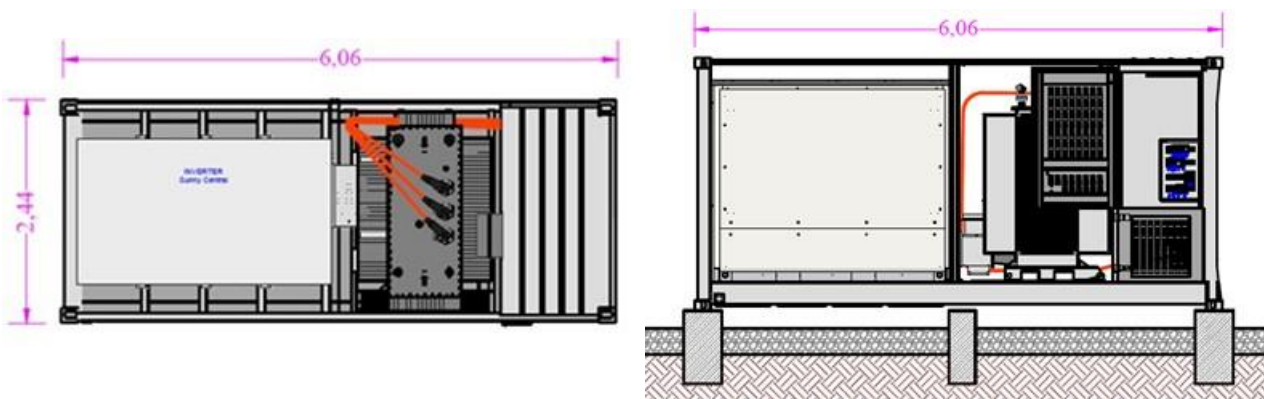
Pianta e profilo dei Cabinet Inverter
